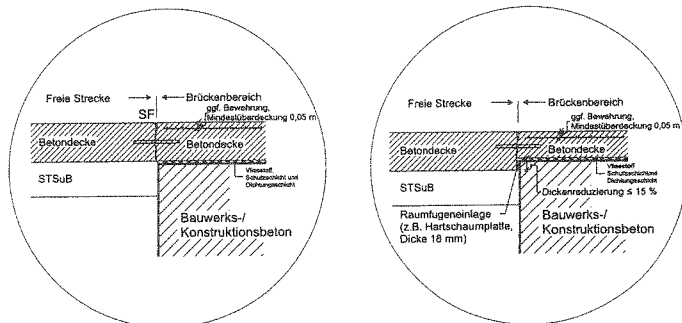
Detail für Bauweise mit STSuB – Übergang von der freien Strecke zum Brückenbereich – links Regelfall, rechts Ausnahmefall mit Dickenreduzierung
